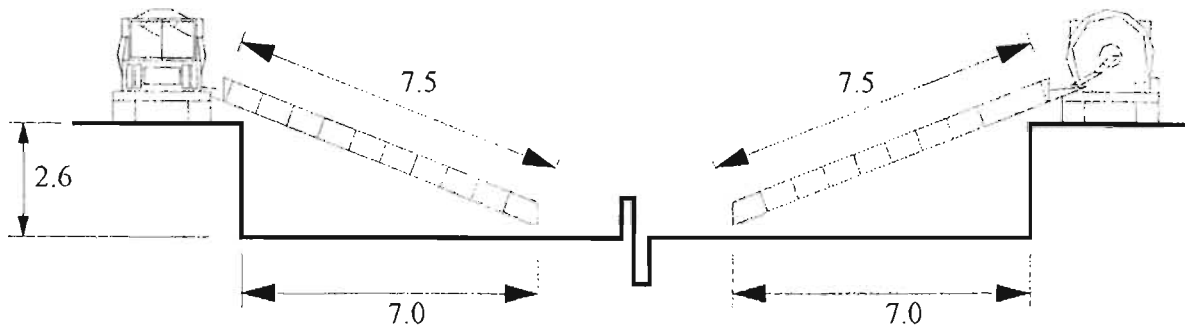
Tiro libre de concreto en colado de cimentación.
